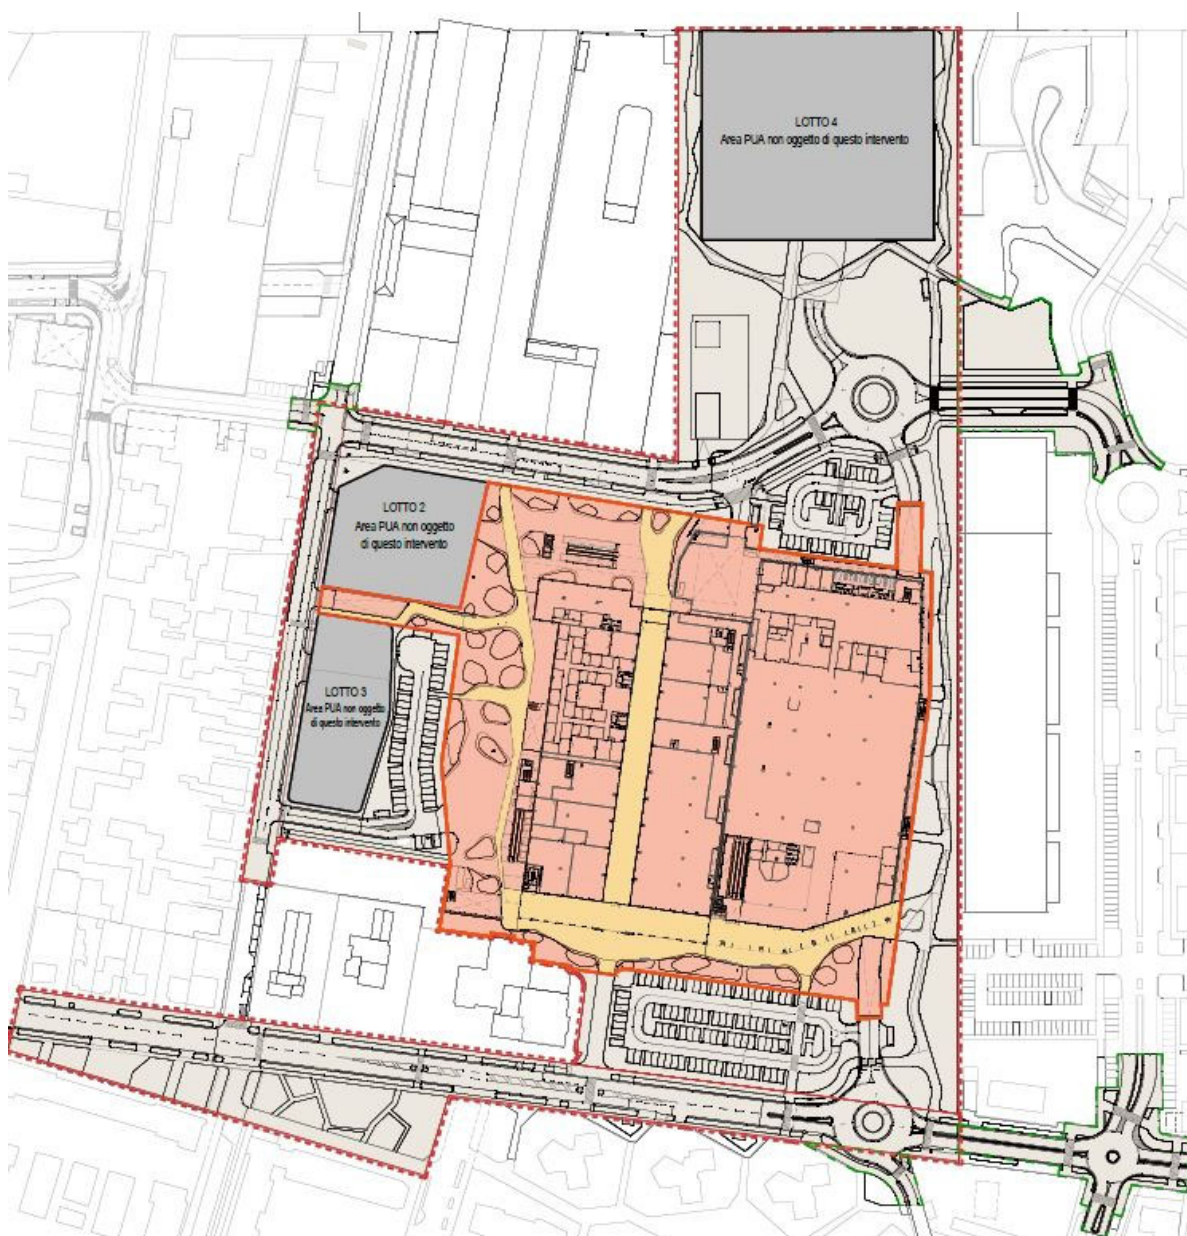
Planimetria estratta dalla tavola di PDC A.01 – Verifica dati del PUA
